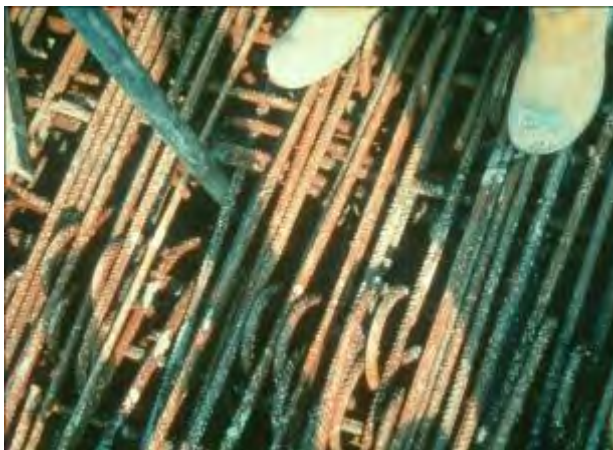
Ungeplante Rüttelgassen und zu dichte Bewehrung machen eine korrekte Betonage nur schwer möglich
